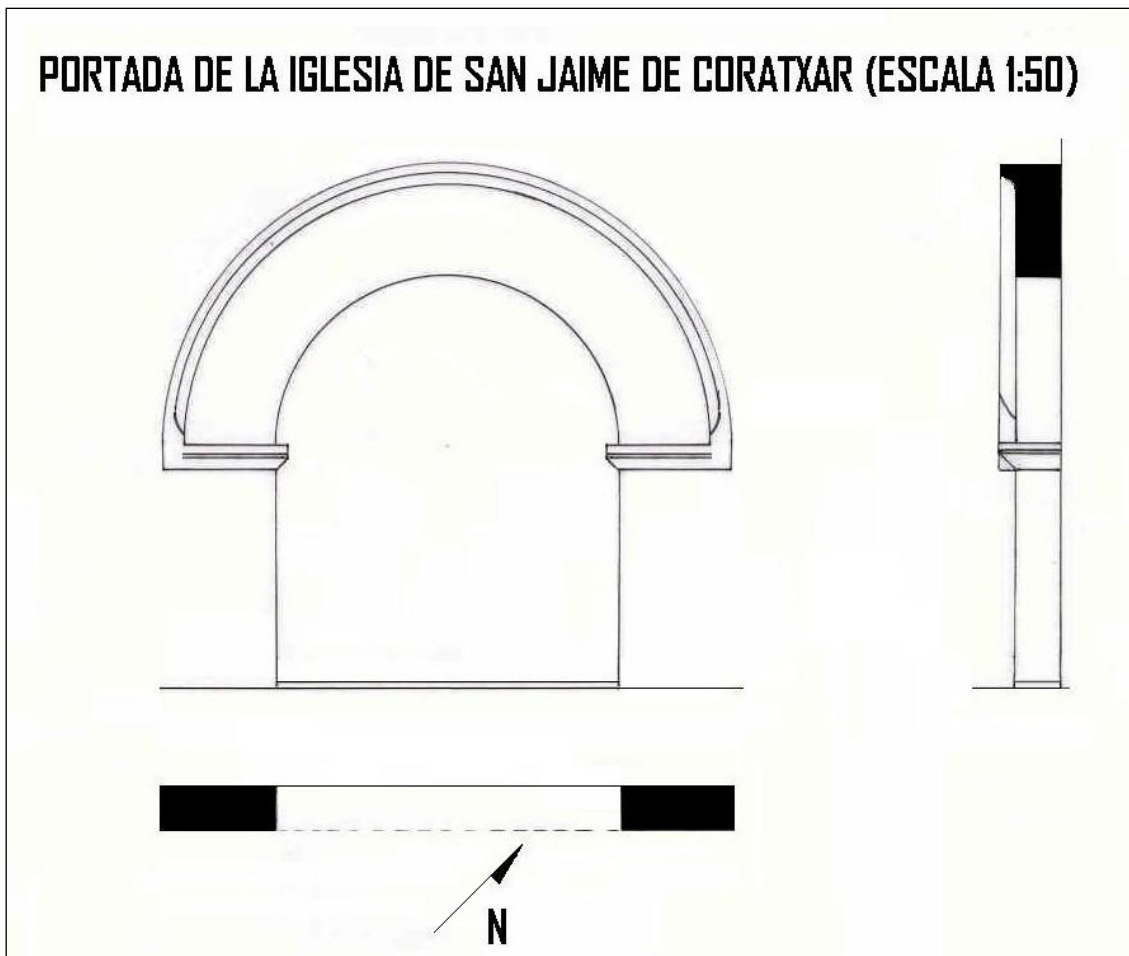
Diseño de la portada en alzado, planta y sección ( Francisco J. Soriano)
